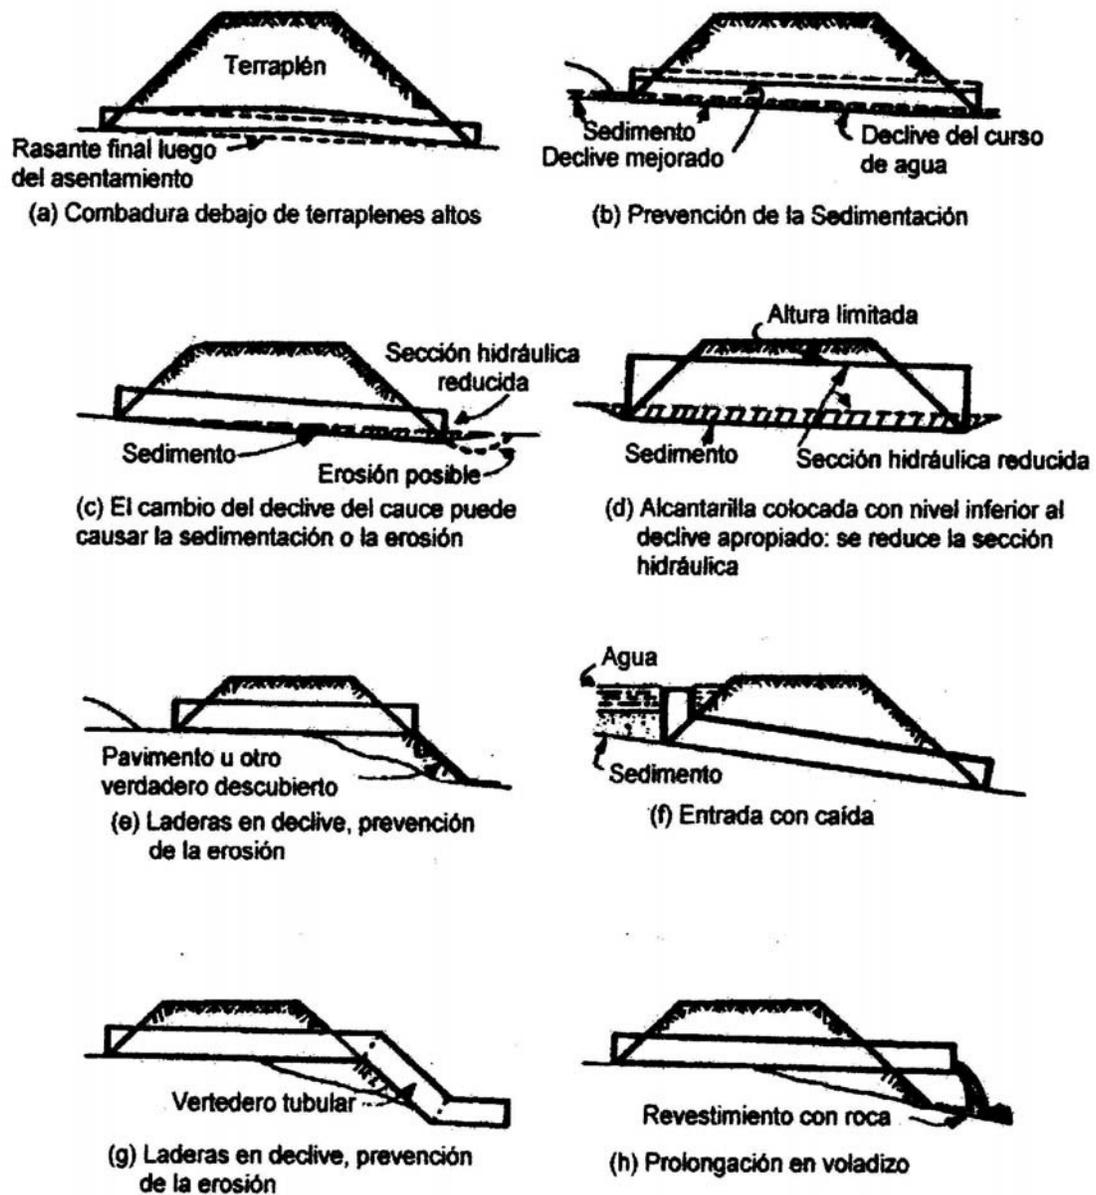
Pendientes apropiadas de las alcantarillas
